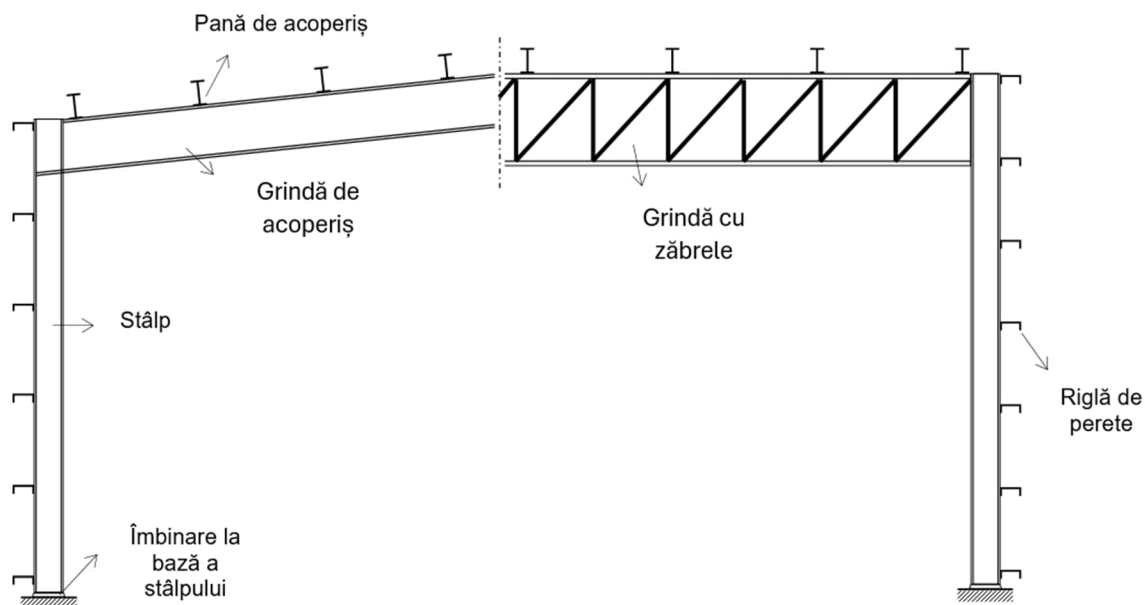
Elemente structurale ale clădirilor tipice cu un singur nivel din oțel
